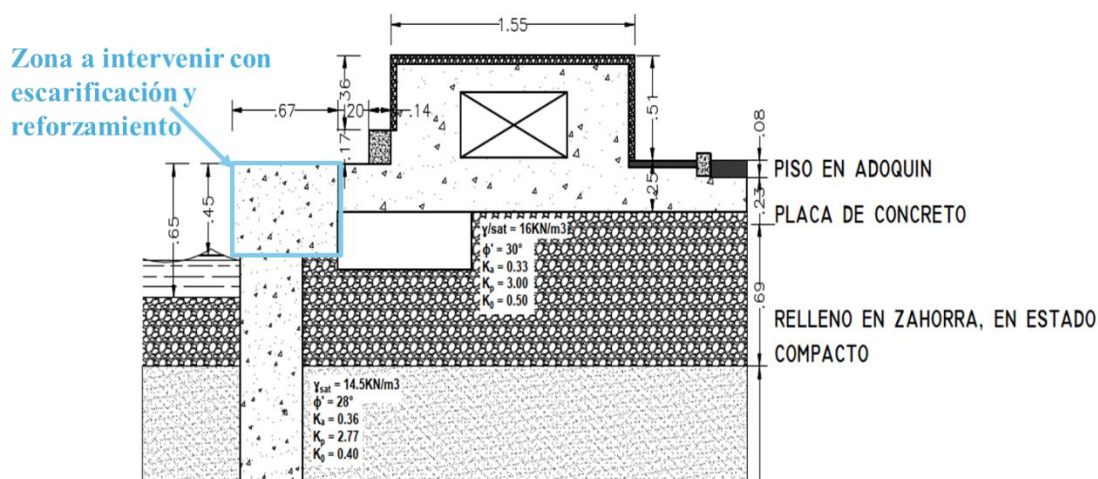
Zona a intervenir en sección transversal para reforzamiento
